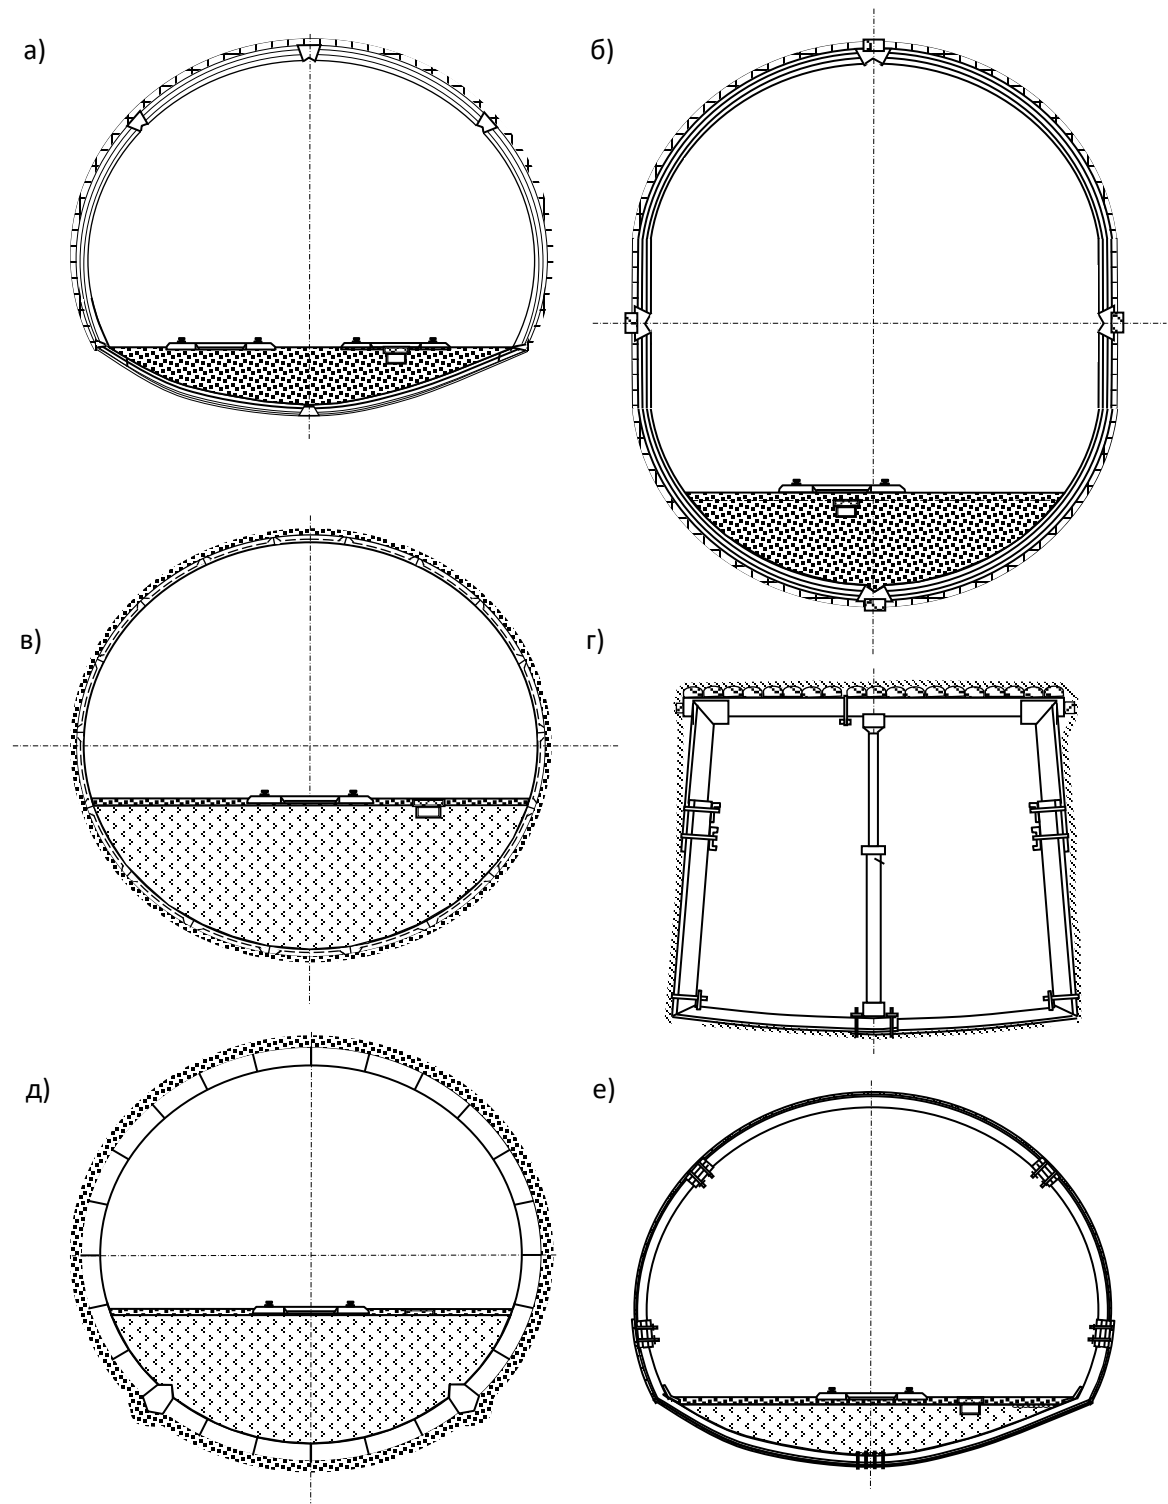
Замкнені конструкції кріплення: а- шарнірне арочне залізобетонне кріплення; б — шарнірне еліптичне залізобетонне кріплення; в- гладкостінне тюрінгове залізобетонне кріплення; г- металеве трапецієподібне піддатливе кріплення з лежнем; д— блокове кільцеве бетонне кріплення; е — металеве піддатливе арочне кріплення зі зворотним склепінням
